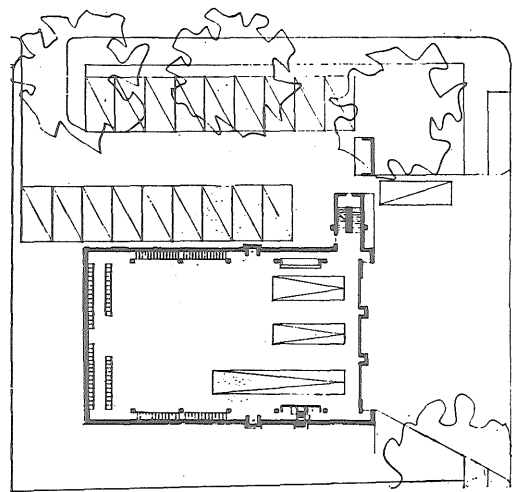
Estación de Whitney Avenue, New Haven. Planta alta.
